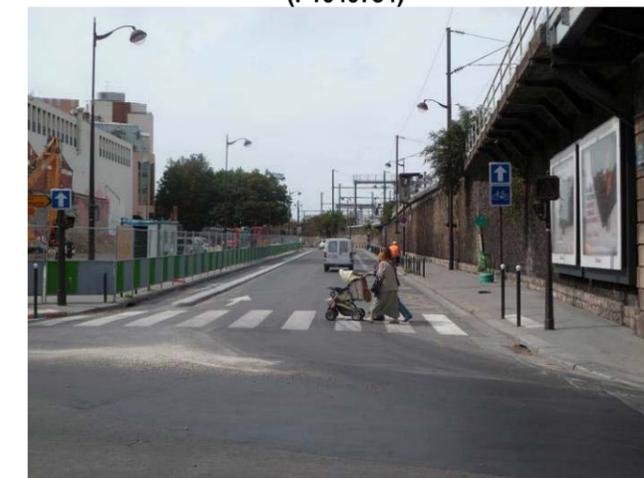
Pont Rail enjambant l'avenue (P1040726)
